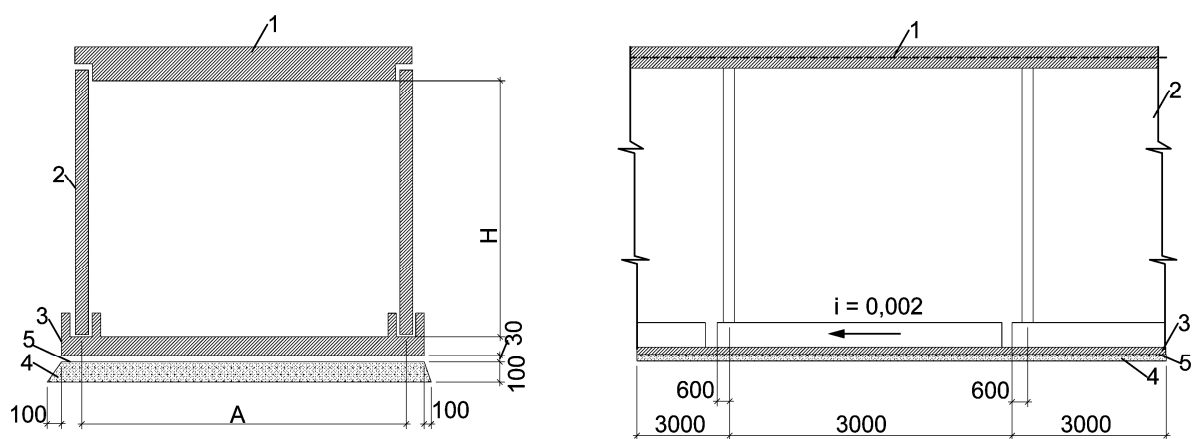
Продольный и поперечный разрезы односекционного тоннеля:
